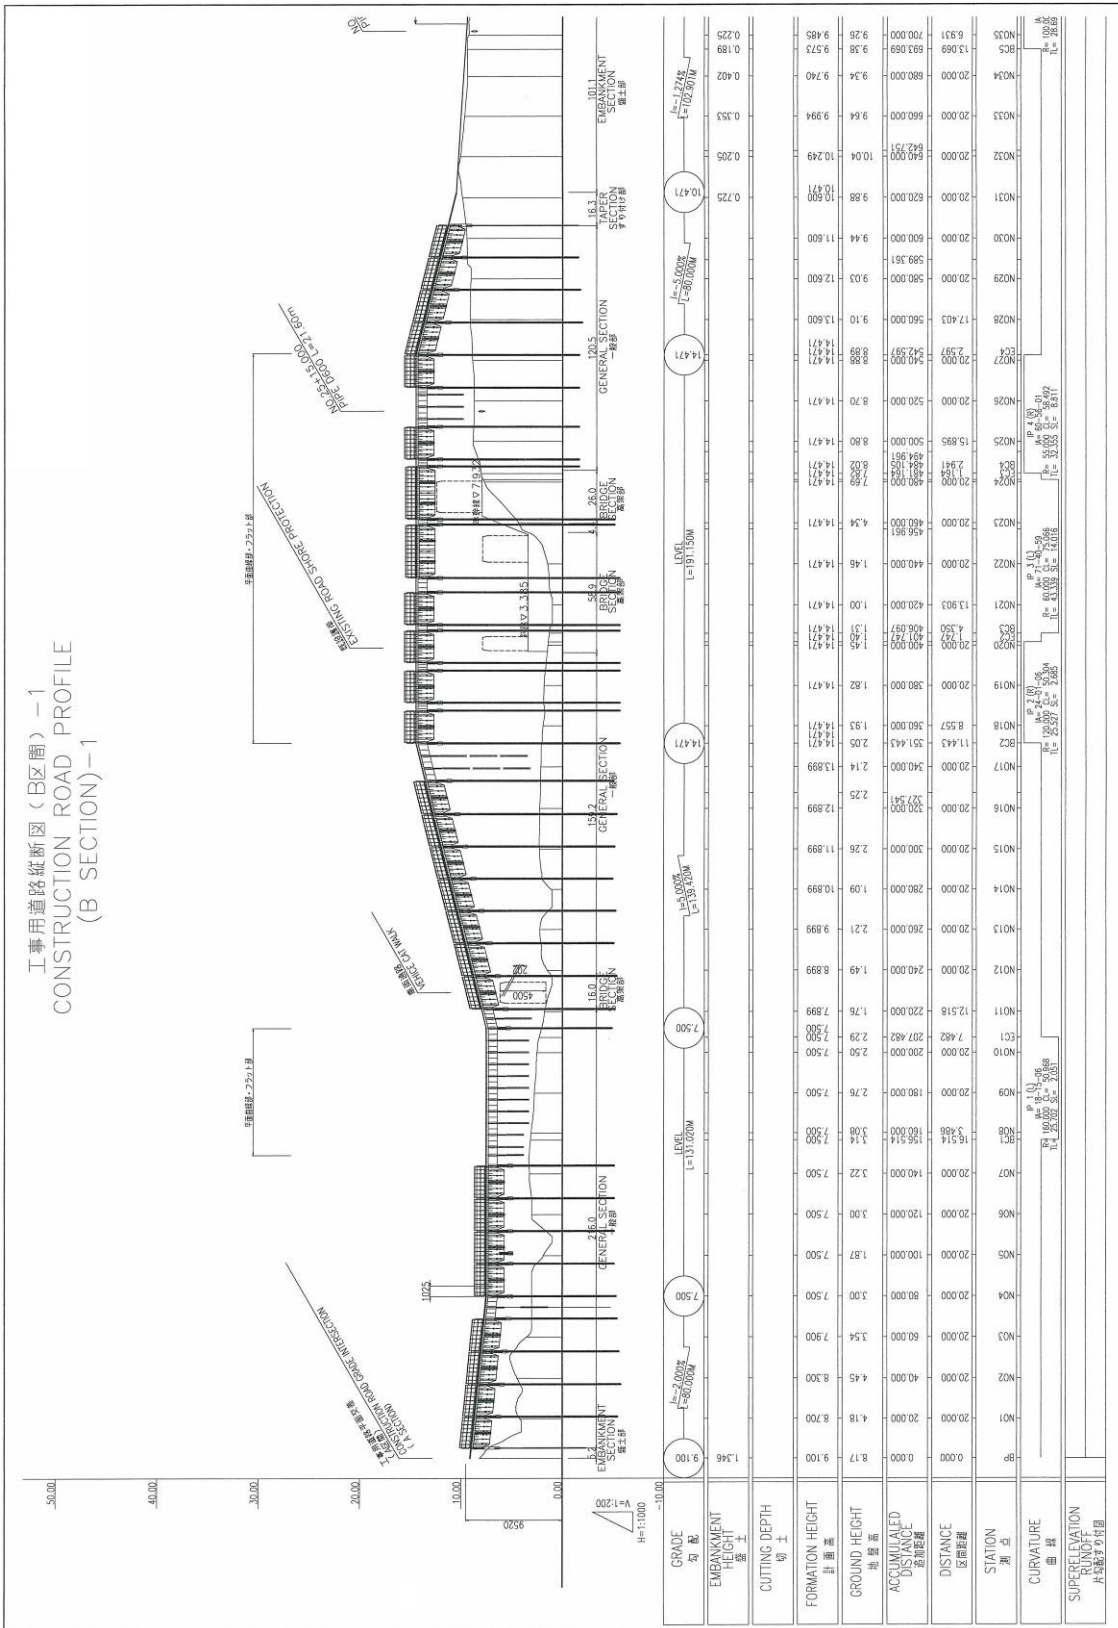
(2) 工事用仮設道路縦断面図 (B区間-1)
